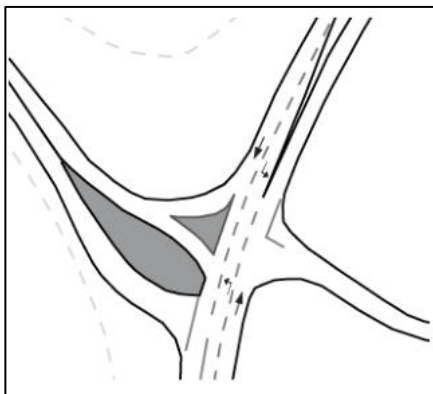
RD 933 et desserte du site de projet, AGENCE B&L - F. BAROT ARCHITECTE DPLG URBANISTE - V.LEYDIER PAYSAGISTE DPLG, juillet 2025
